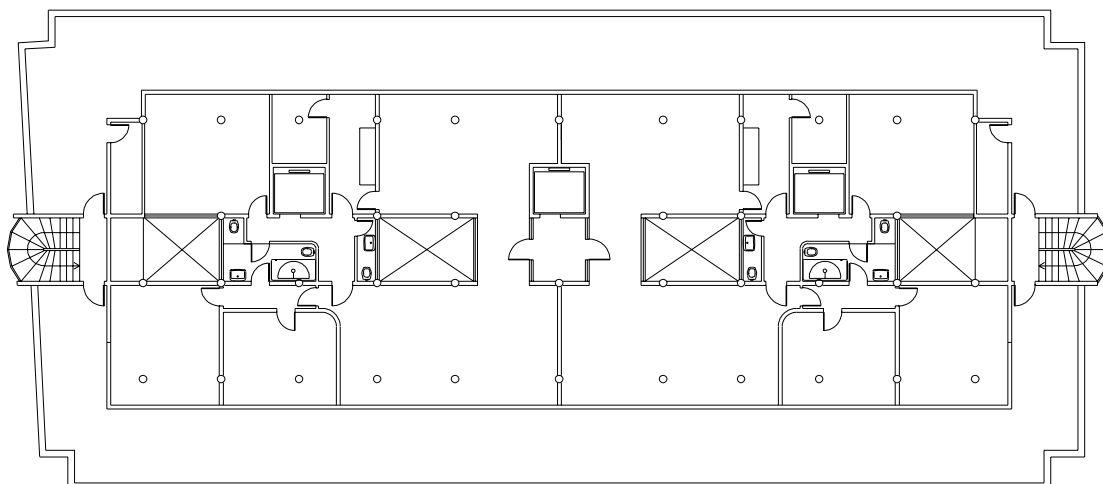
Planta dos apartamentos do décimo pavimento. Notar a conformação original do terraço-jardim.
